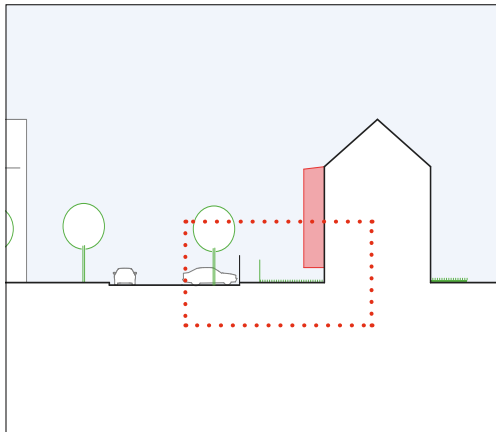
TG unter Terrasse, Detailschnitt Regensburg
